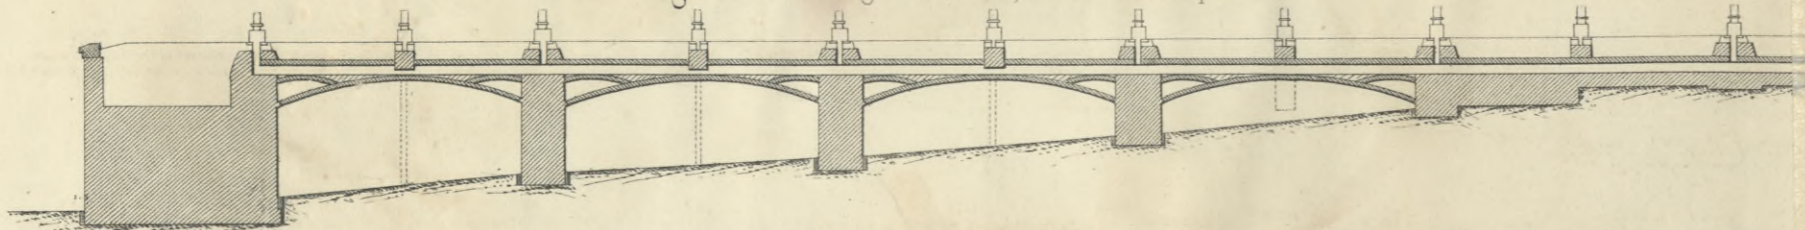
Profil en long sous la façade Ouest à 0^m005 p.1^m
